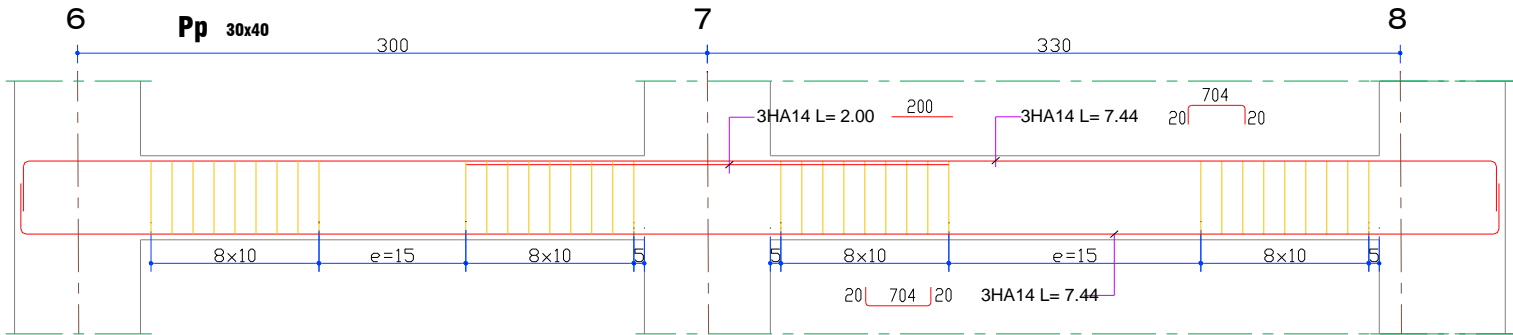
Exemple de ferrailage des poutres principales au niveau de portique 1 de niveaux sous-sol, RDC et terrasse.
